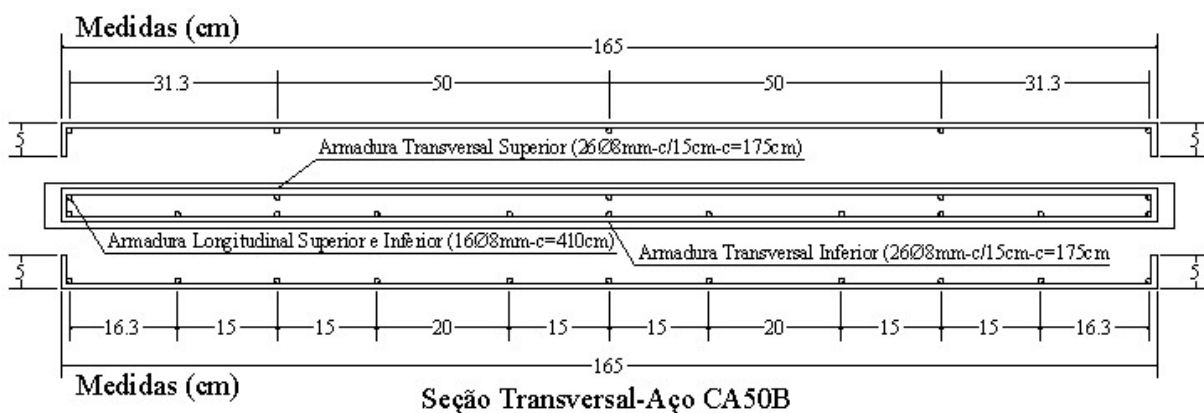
Detalhamento da armadura da laje de concreto da ponte de madeira-concreto
